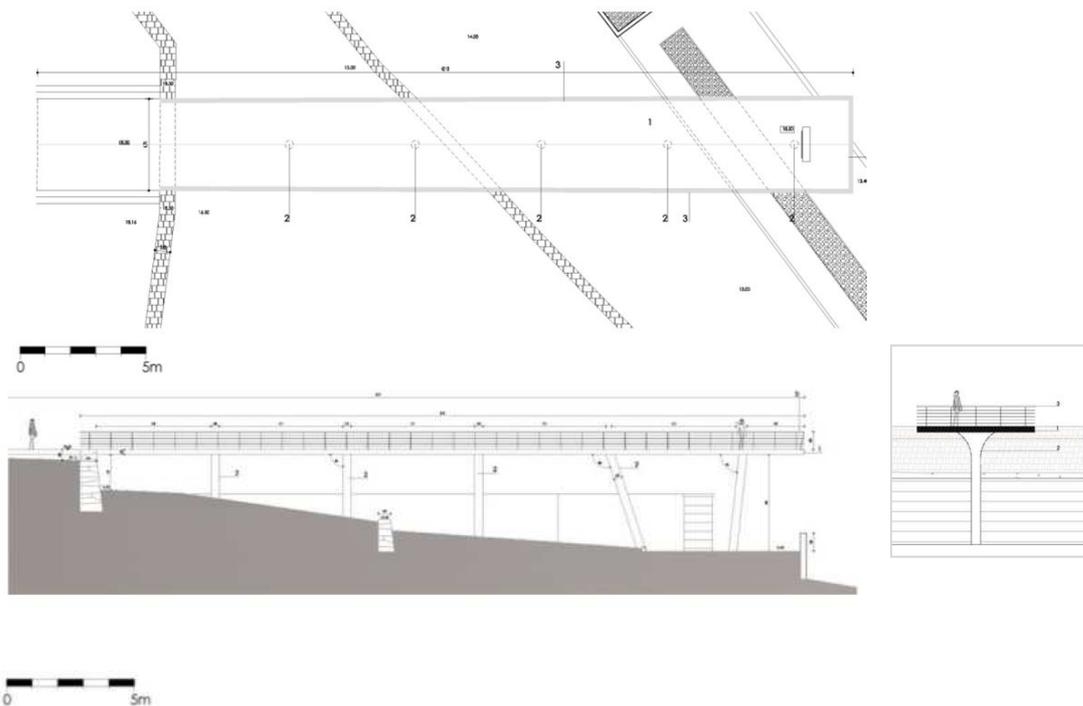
Mirante, em cima: Planta; em baixo: Alçado longitudinal; à direita, alçado frontal.
